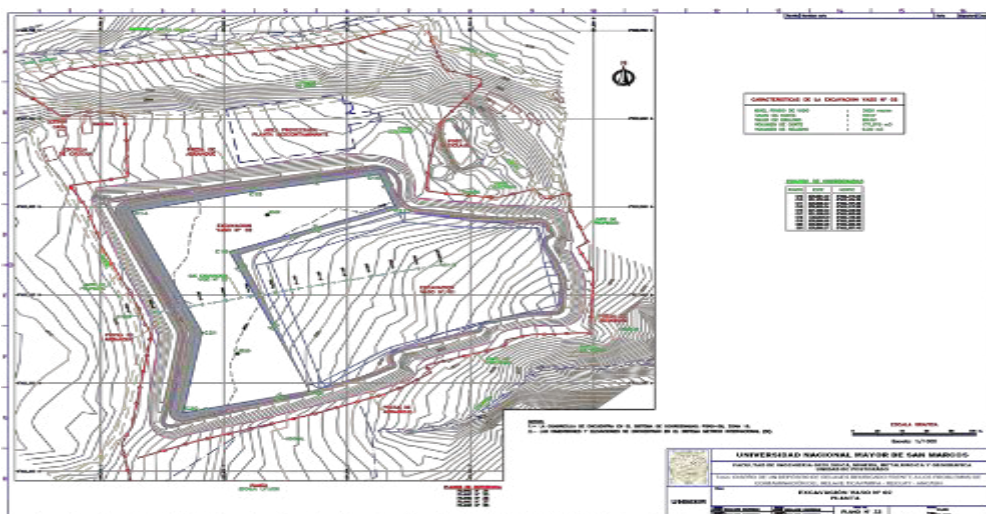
Plano en planta de diseño (Vaso N° 02).
